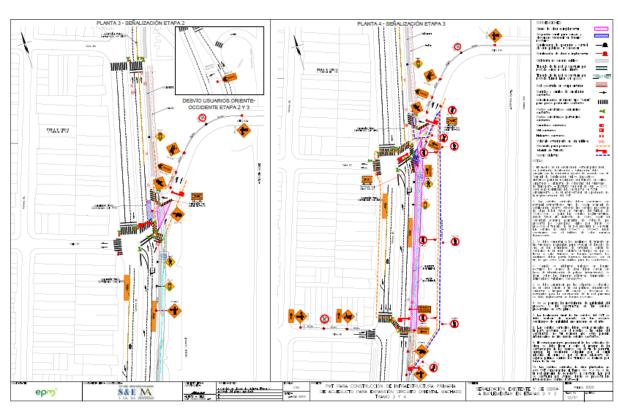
Presentación de Planos Fuente. PMT Conducción Machado-Volador
